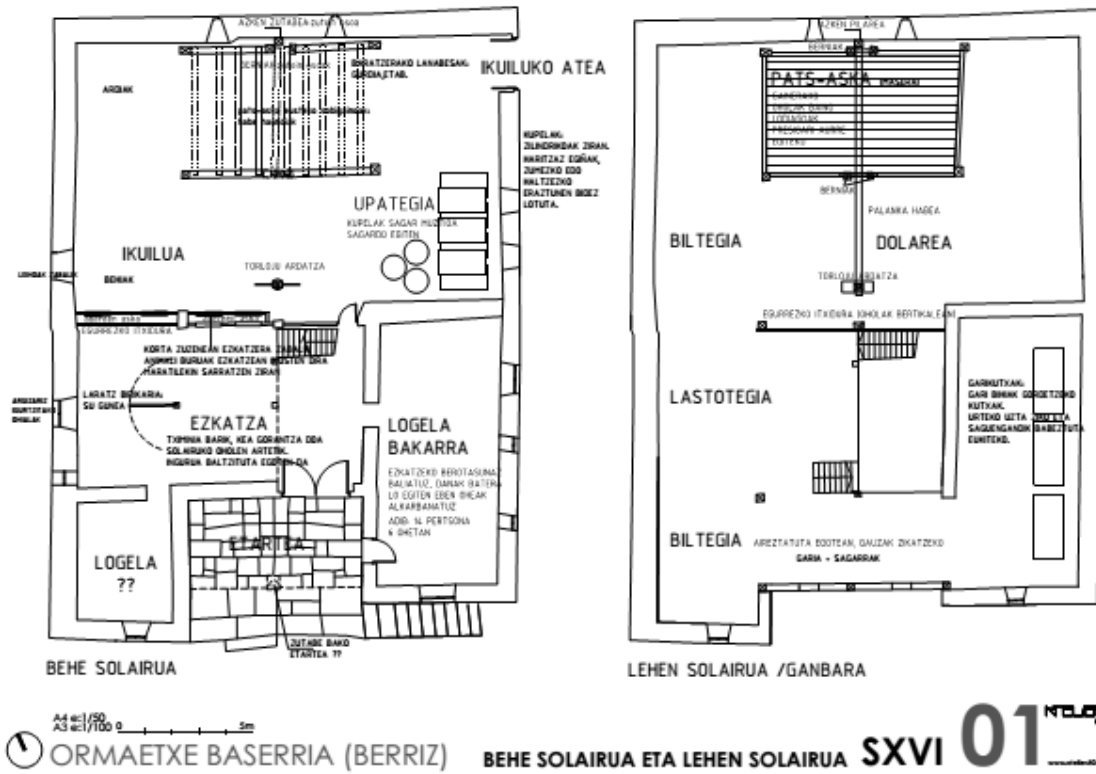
Propuesta de distribución interior de elementos en planta, Besoitaormatxe Baserria para el siglo XVI. Planta baja (izq) y primera planta (dch): parte trasera (Dolarea: lagar; Upategia: zona para las barricadas). Autor: Atelier80 Arquitectos.
